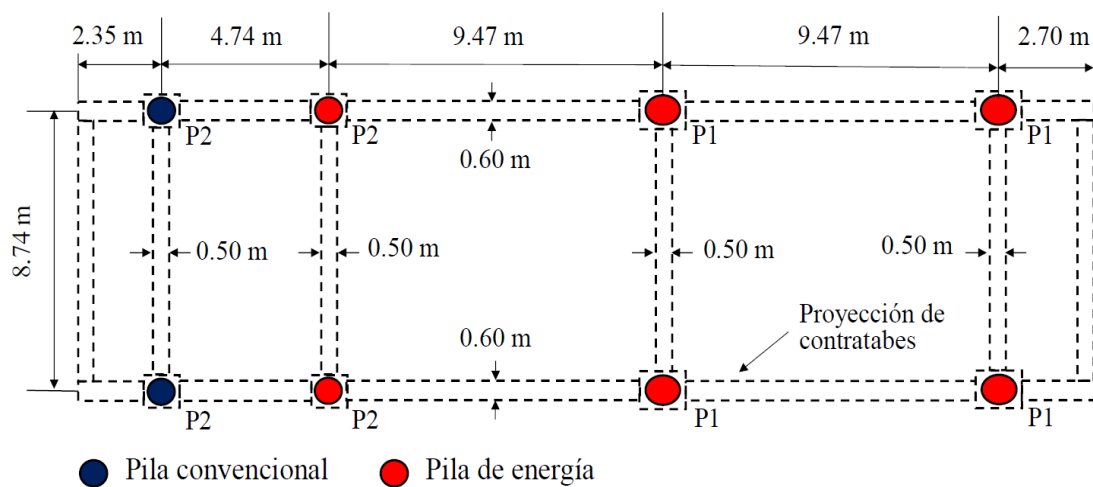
Planta de cimentación del proyecto (López-Acosta y Barba, 2022)
